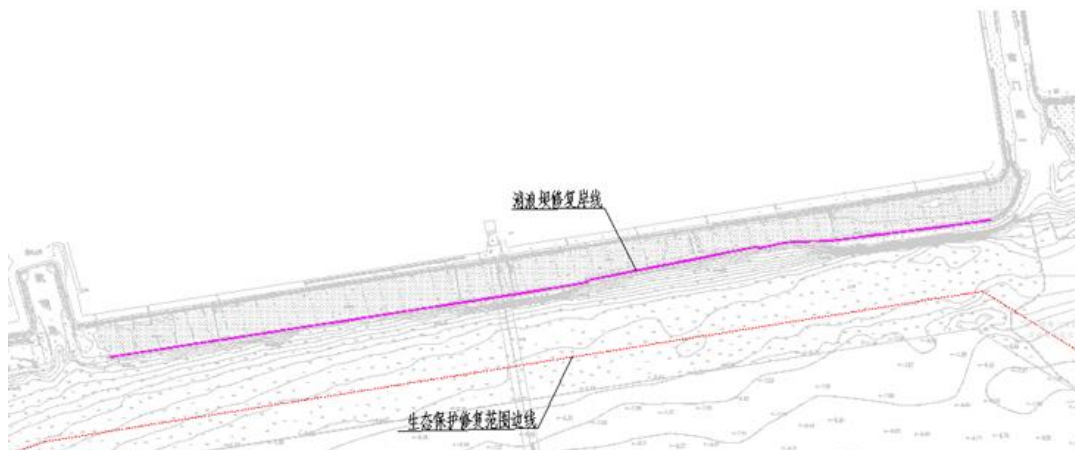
金汇塘东段岸段原设计消浪坝修复平面图
